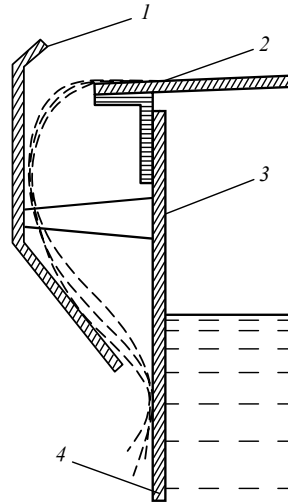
Напрячний пояс для стоку води на корпус резервуара: 1 — напрячний пояс; 2 — дах резервуара; 3 — кронштейн; 4 — стінка
